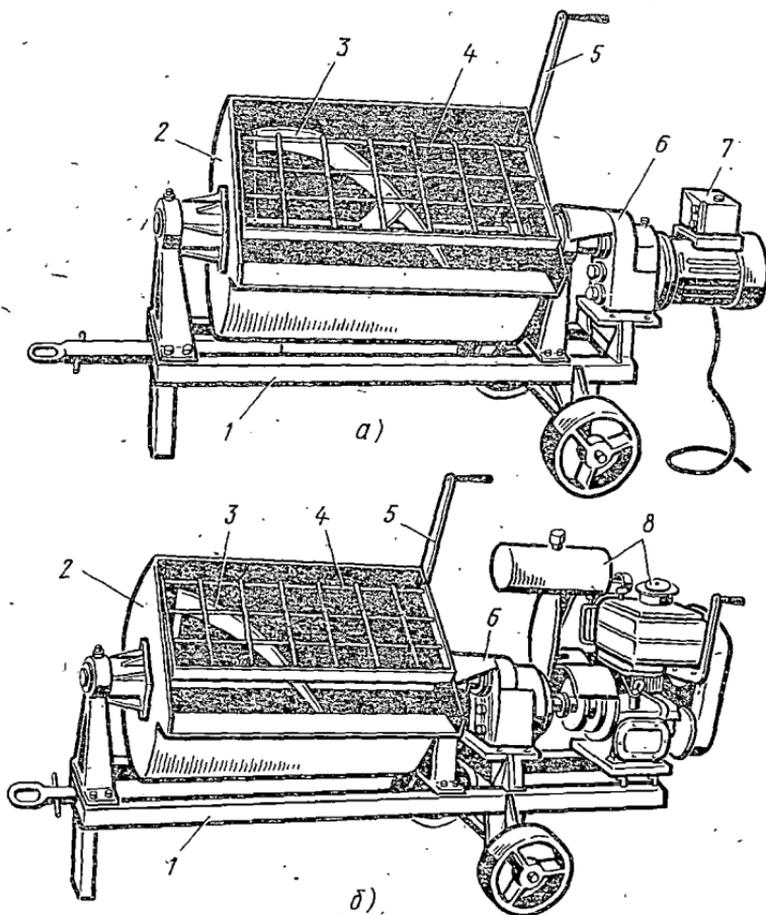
Передвижные растворосмесители СО-46А (а) и СО-26Б (б): 1 — одноосная тележка, 2 — смесительный барабан, 3 — лопастный вал, 4 — откидная решетка, 5 — ручка, 6 — редуктор, 7 — электродвигатель, 8 — двигатель внутреннего сгорания
